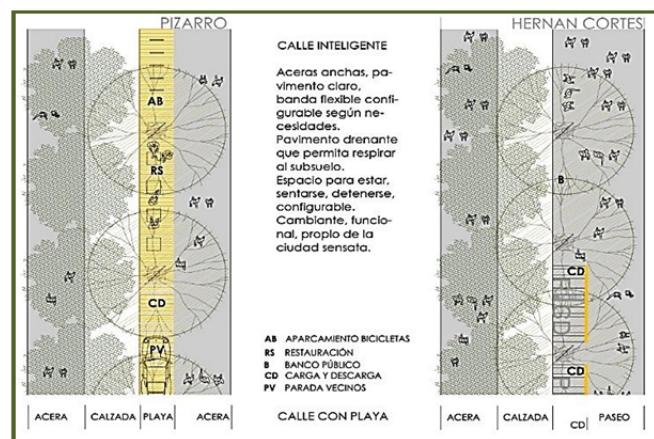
Plantas I Fuente: © EFG arquitectura
